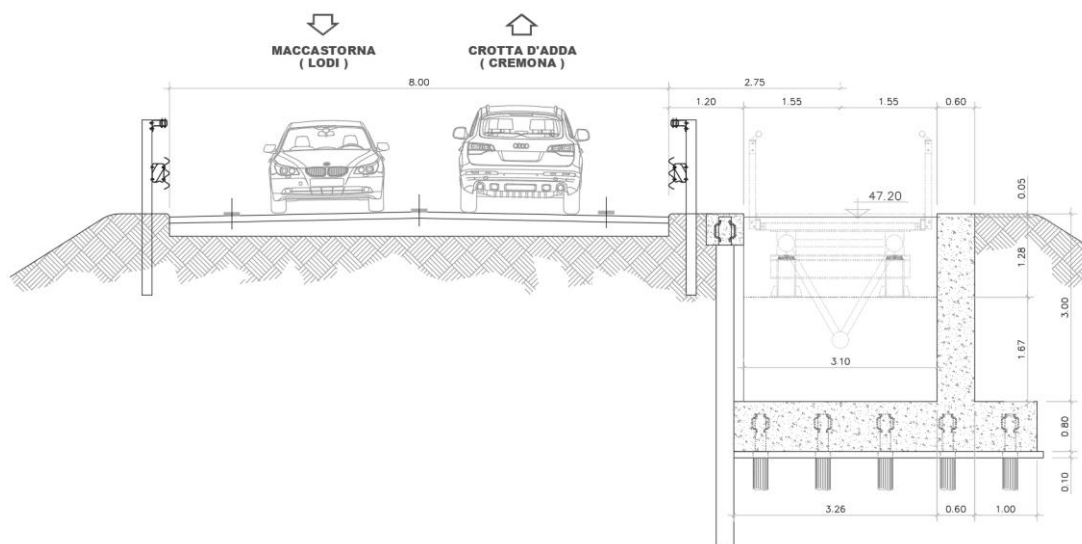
Sezione in corrispondenza con la spalla della passerella
